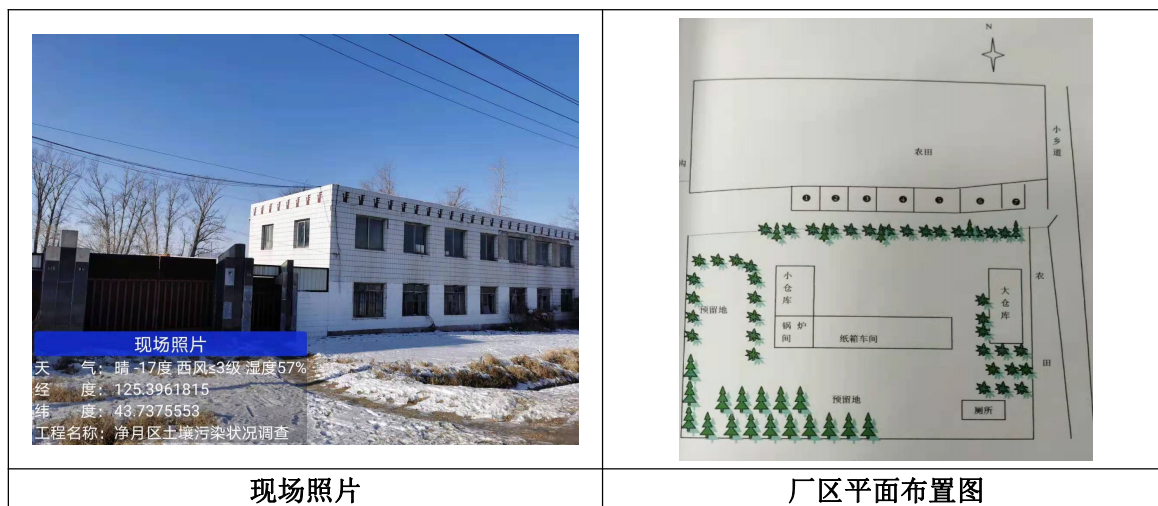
宇鑫工艺品厂现场情况及平面布置图
